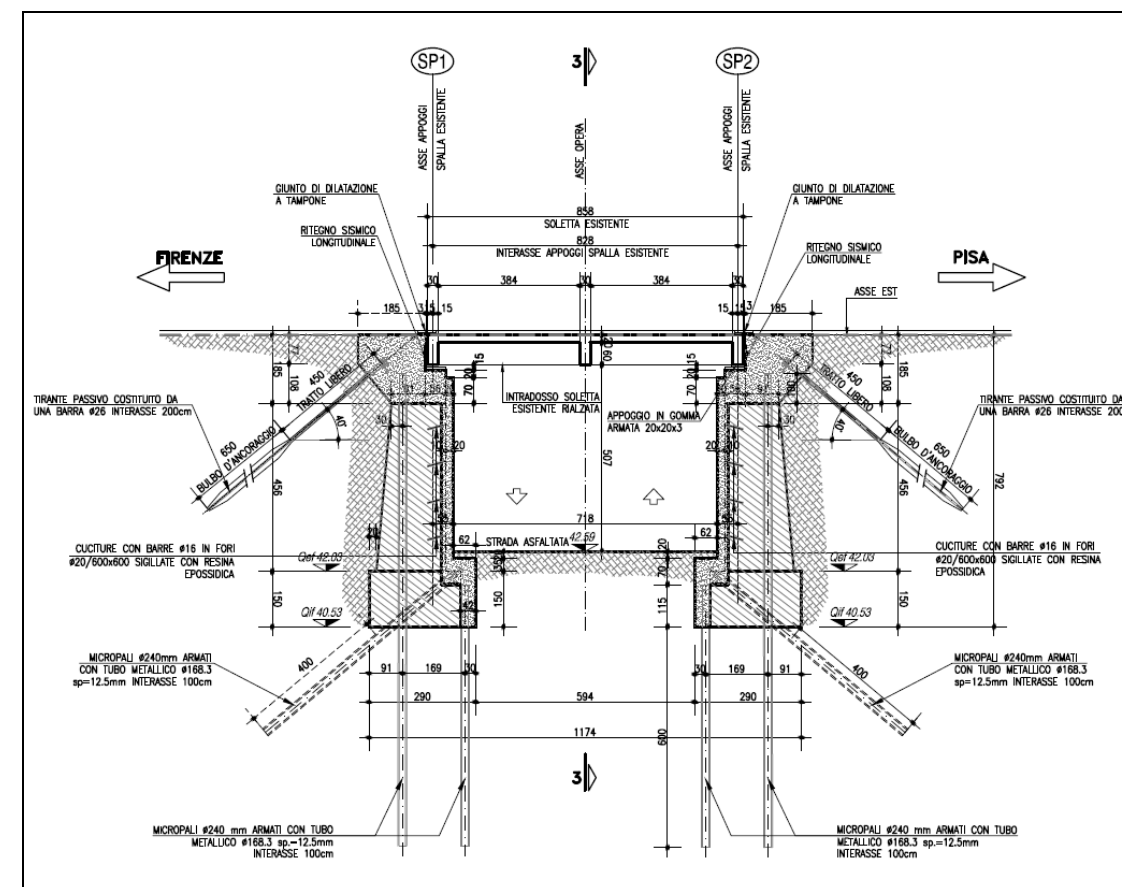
Sottovia di via del Ferro. Sezione longitudinale
